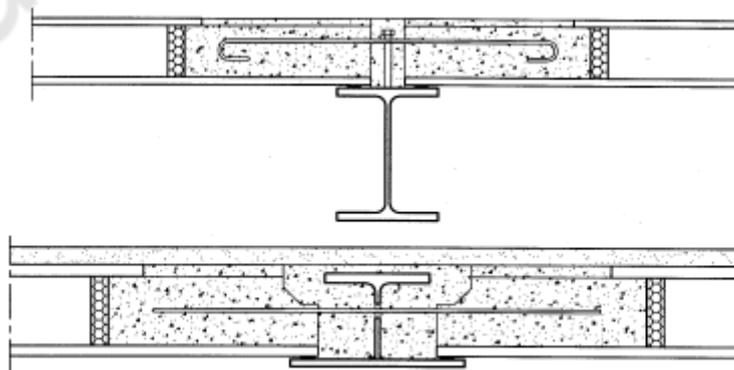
Exemples de planchers posés sur des poutres en acier
